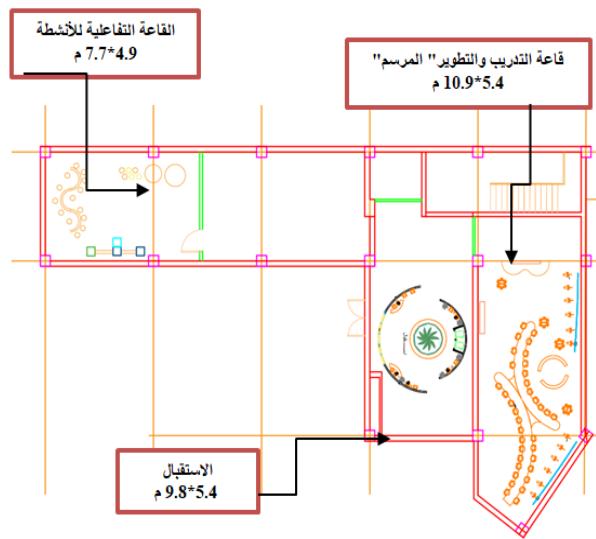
يوضح مسقط افقي للدور الأرضي لجمعية اشراق
